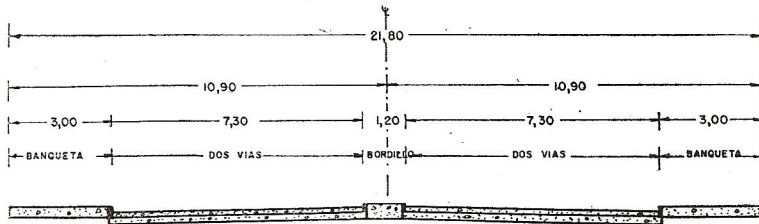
Sección típica de Estación +250 a +640 (paso del barranco).
